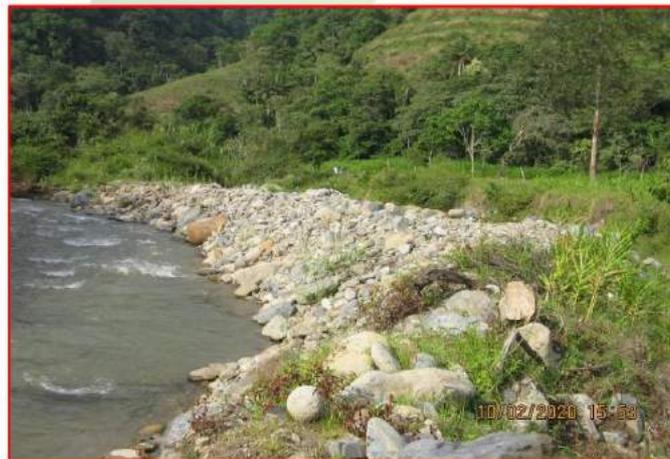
Muro Armado – Jarillón (Vista Lateral)
